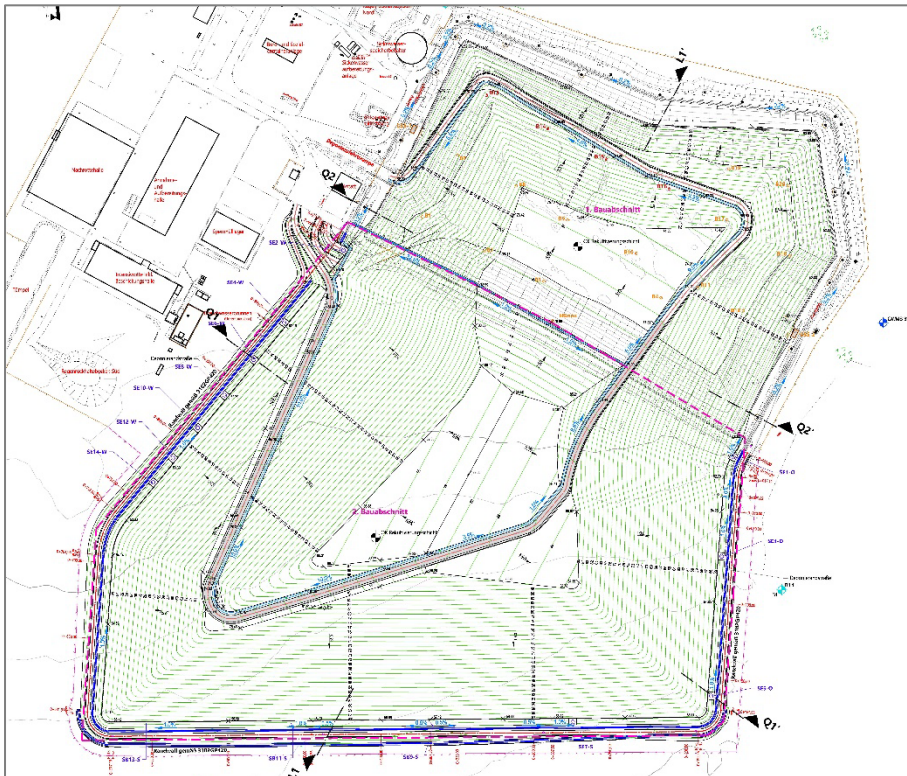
Deponie Lindenberg, Lageplan OK Rekultivierung bzw. OK Oberflächenabdichtung 1. und 2. BA (aus Plan GP140a, Anlage 3)
